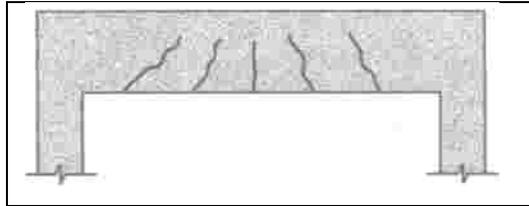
Pandeo y fisuras en viga¹³
